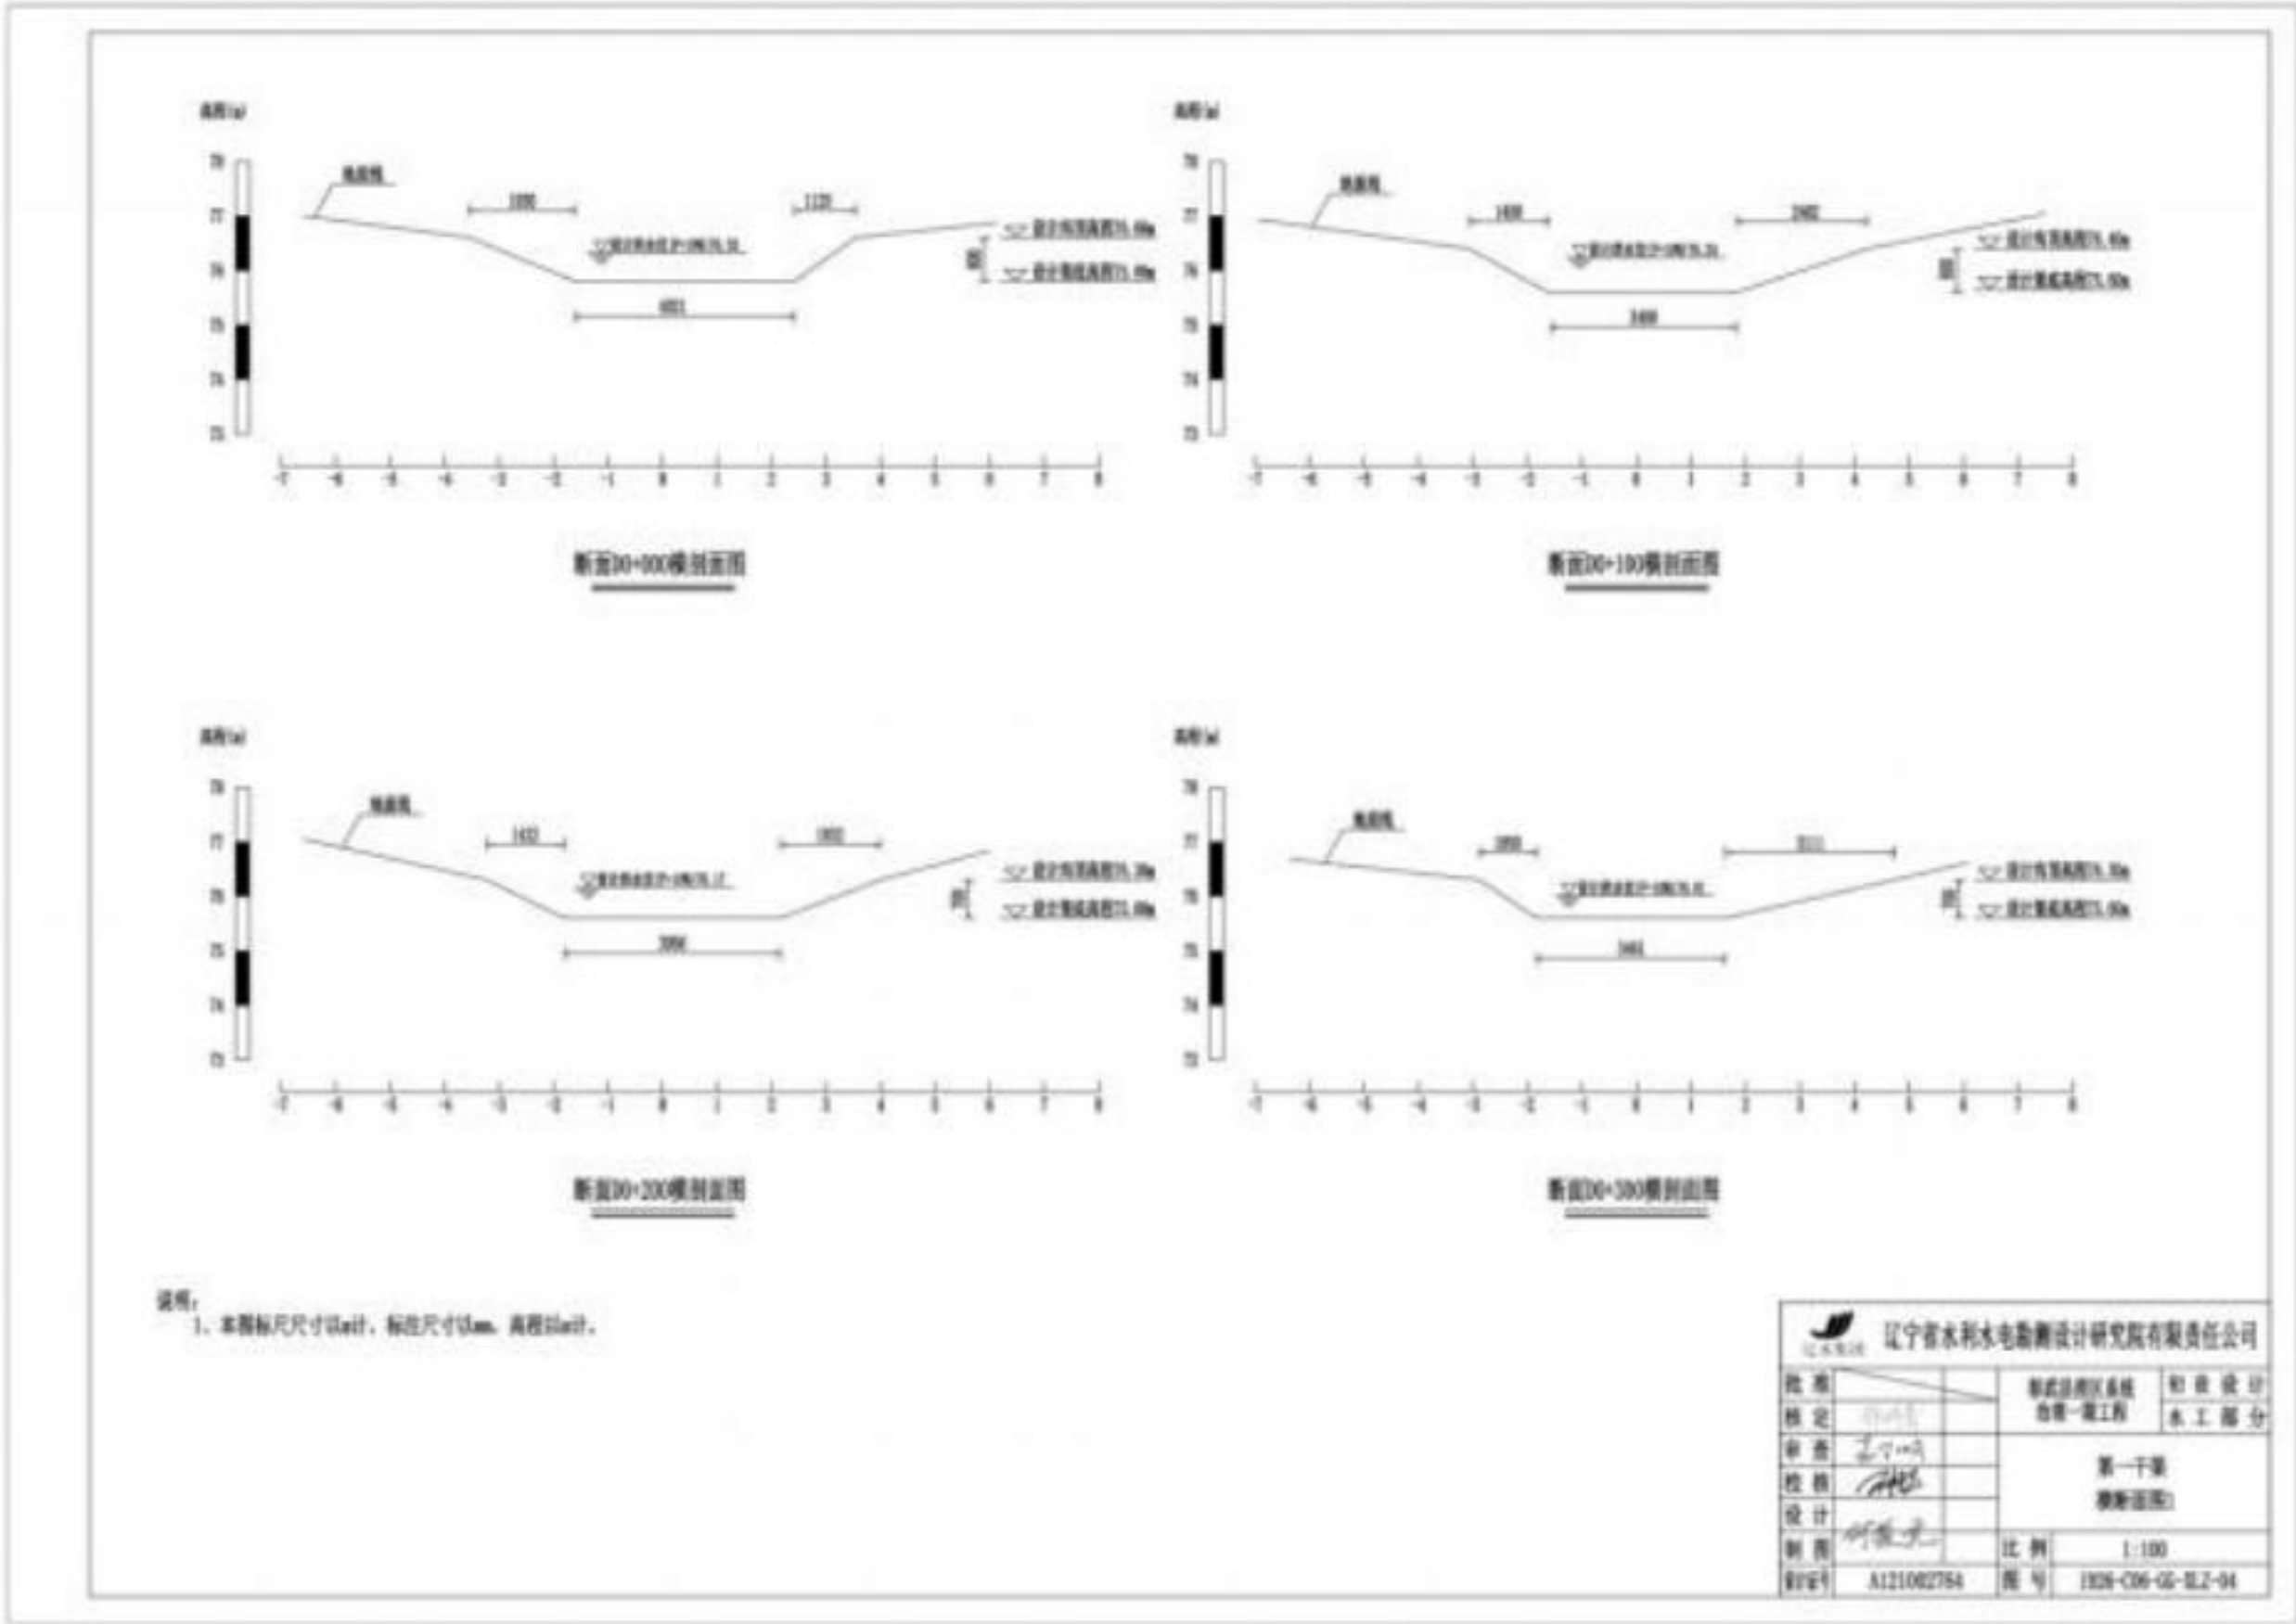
(1) 西六家子镇第一干渠剖面图
